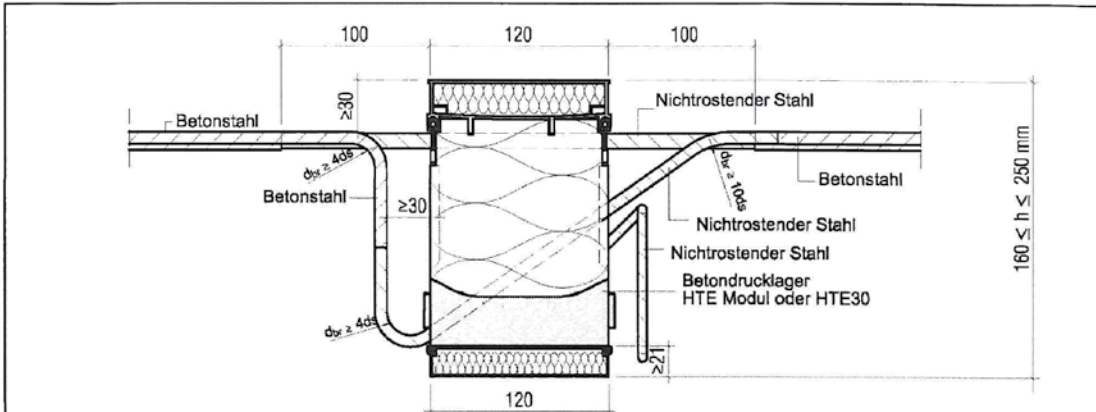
Schöck Isokorb Typ K¹⁾ mit integrierter Aufhängebewehrung gem. Abschn. 3.3.1 und Sonderbügel
